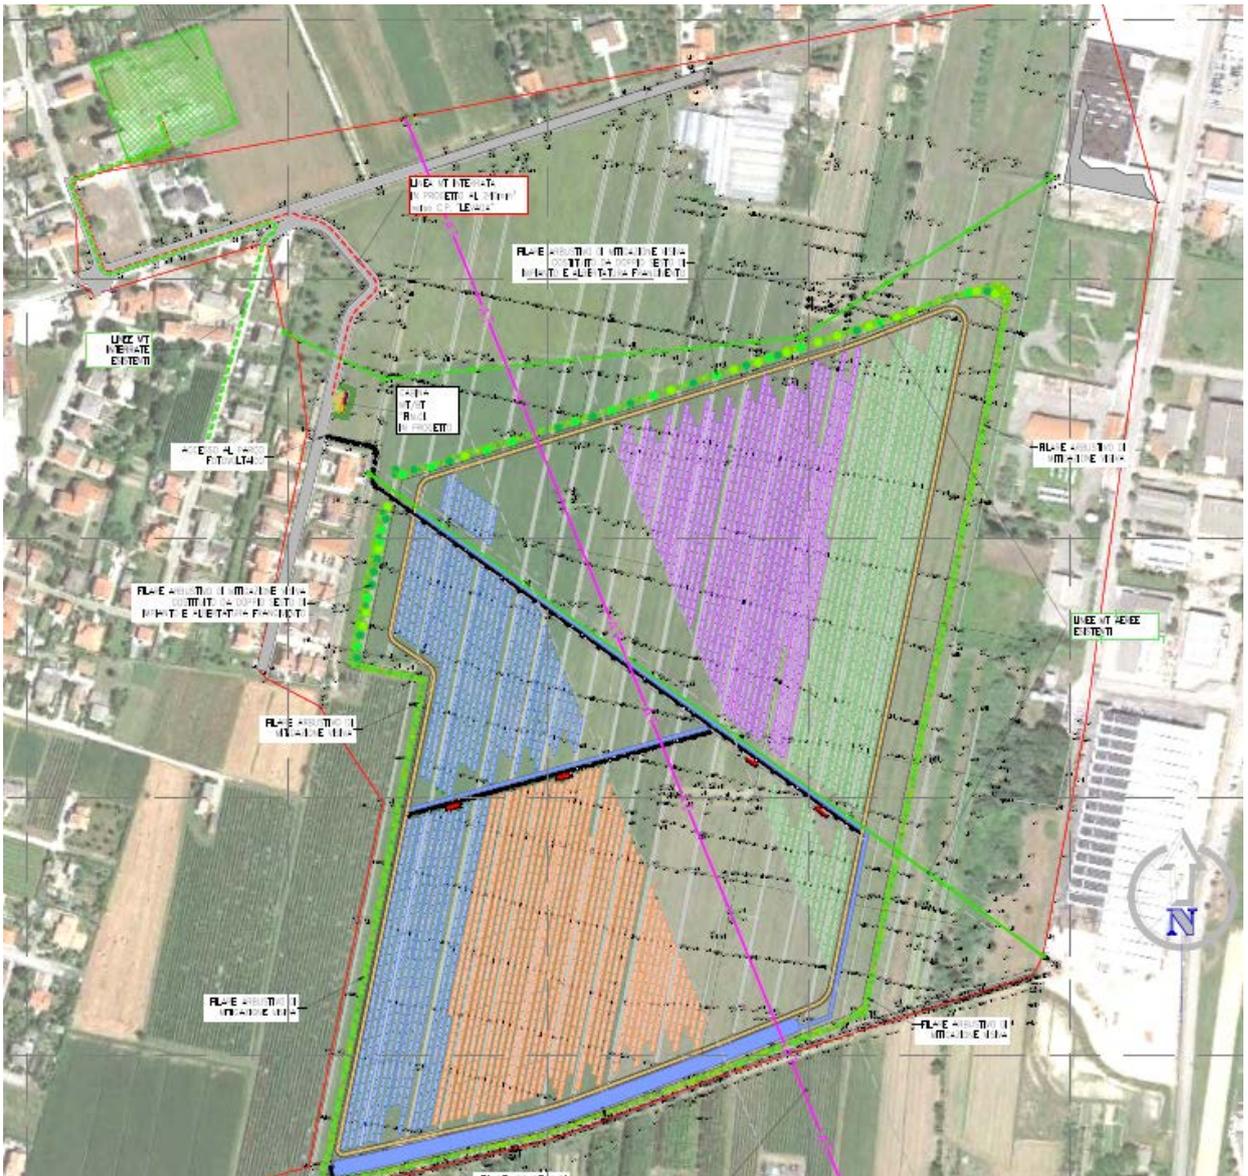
planimetria di progetto con indicazione dei pannelli e delle principali opere interessate dell'impianto
